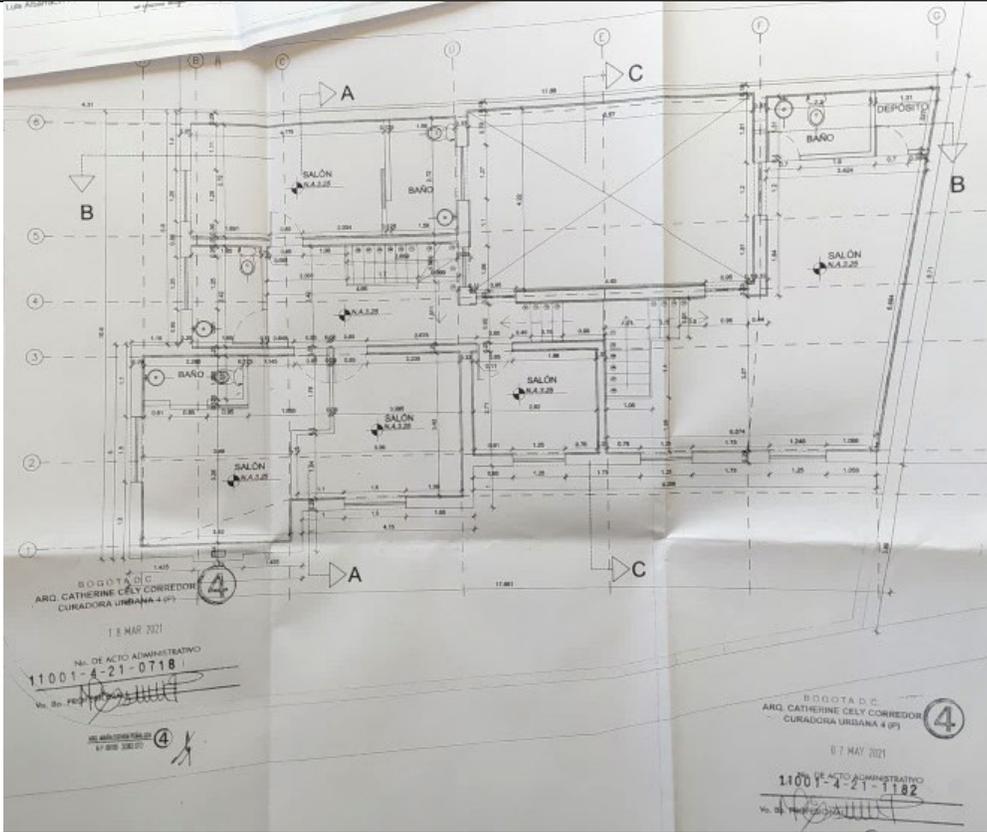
Plano de planta segundo piso propuesta con sellos de la Licencia de Construcción No. 11001-4-21-1182.
